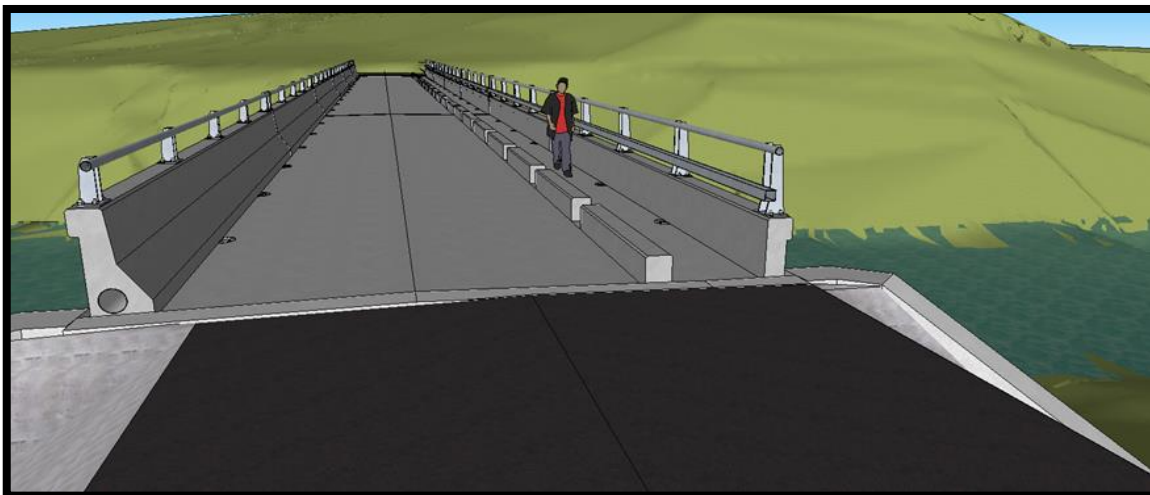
corte de superestructura (Indicación de New Jersey)
